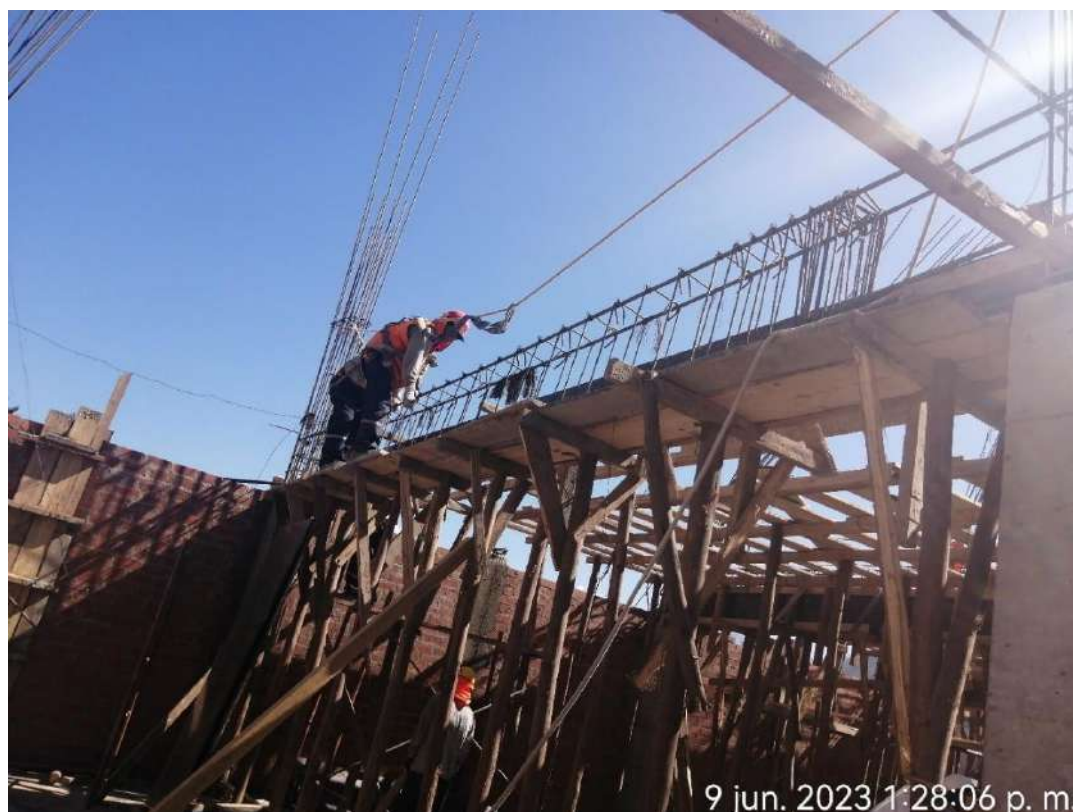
Encofrado y acero de refuerzo en vigas del 2do nivel
